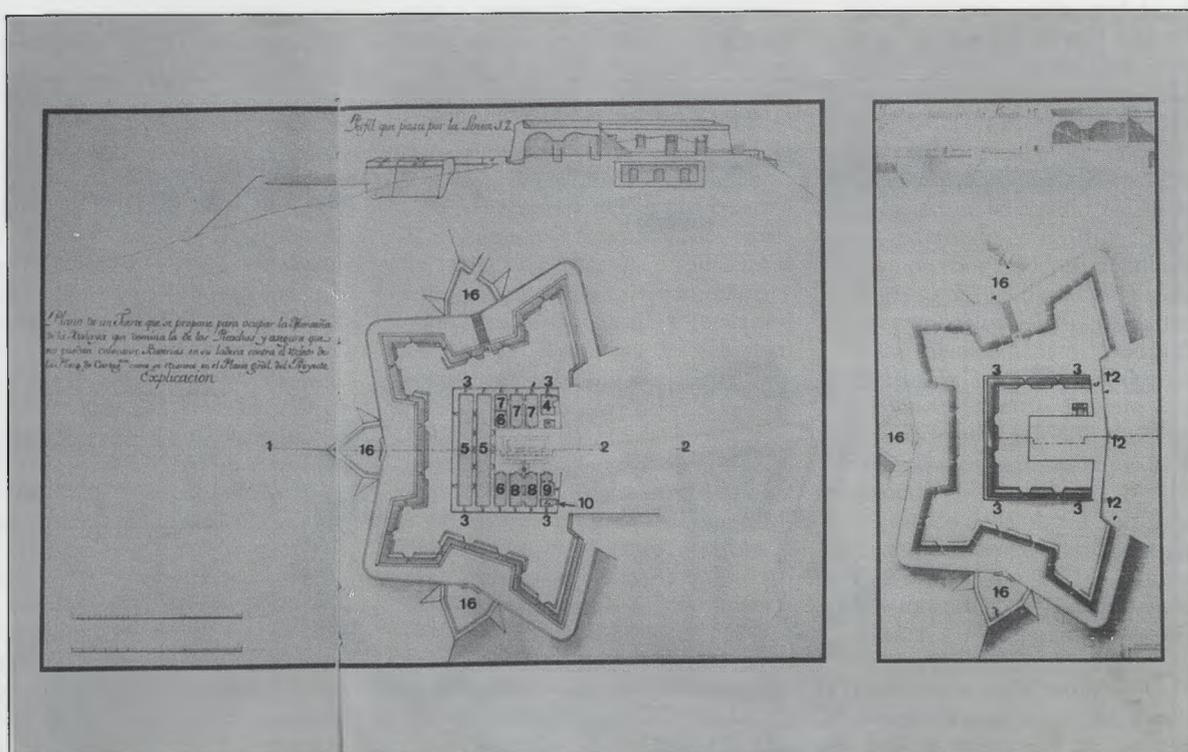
Nº 1 Planta del fuerte de las Galeras y muralla de unión con el Malecón y su fortín, F. LLOBET.
